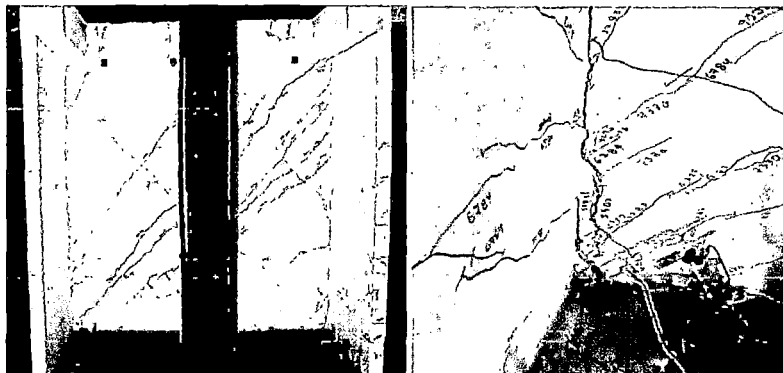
Distorsión 1/154: Vista sur y norte de las grietas en el alma.
